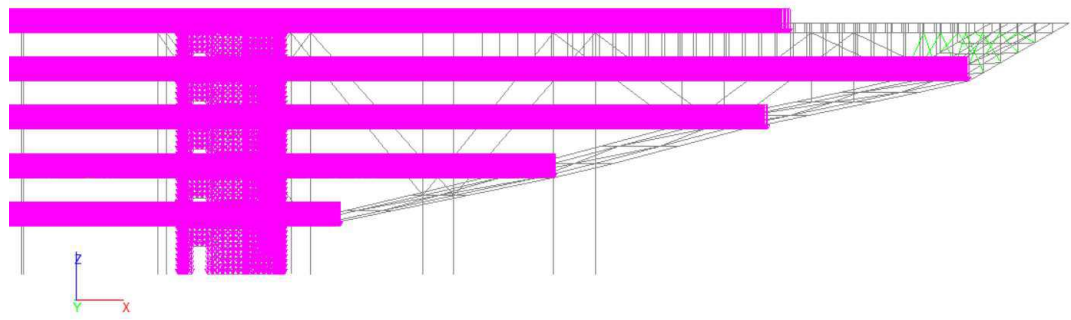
Нагрузка от собственного веса железобетонных конструкций (фрагмент здания)
